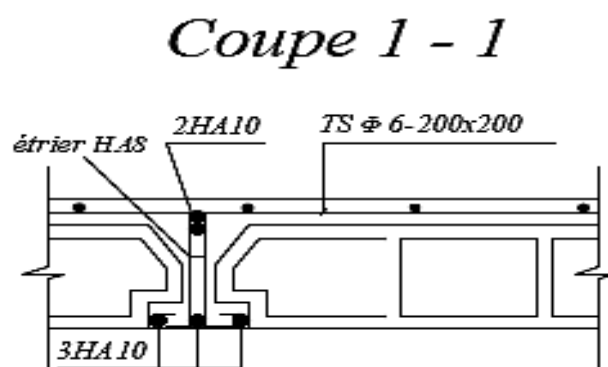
Coupe schématique du ferrailage du plancher.
